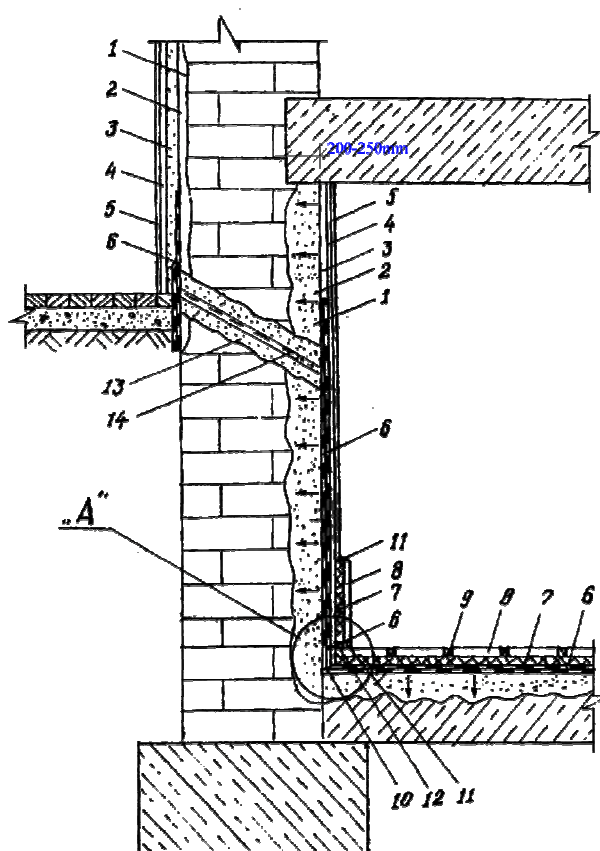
Устройство отсекающей гидроизоляции на уровне цоколя с внутренней кальмирующей (проникающей на 200–250 мм) гидроизоляцией по стенам и полу подвала
